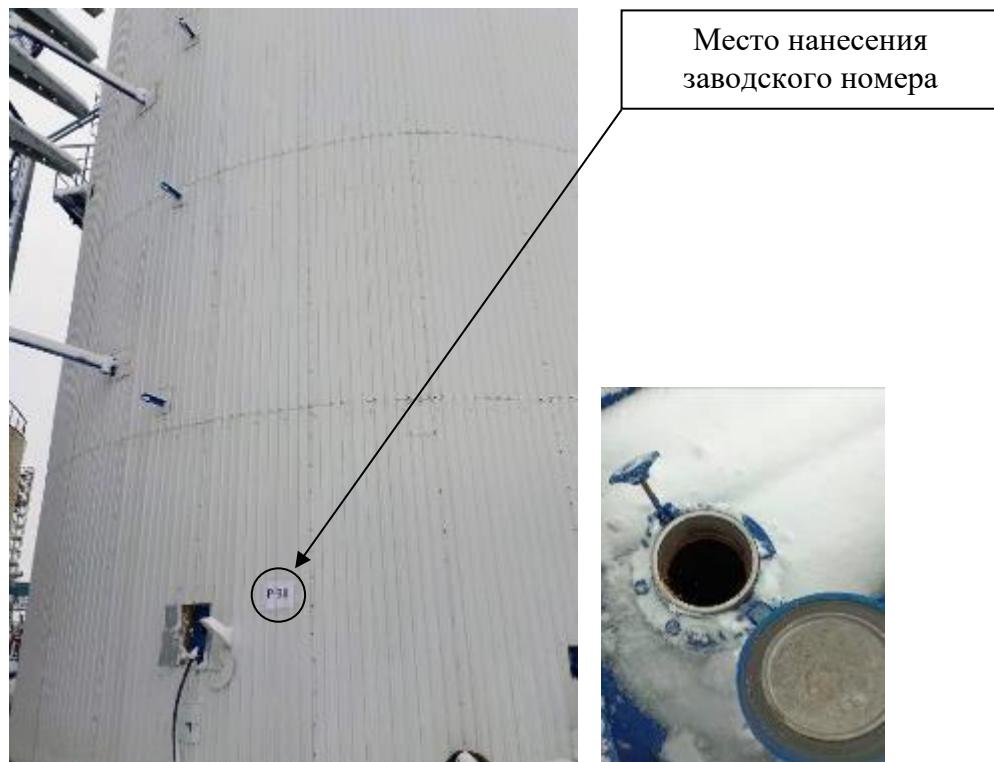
Общий вид резервуара с заводским номером 5 и его замерного люка
